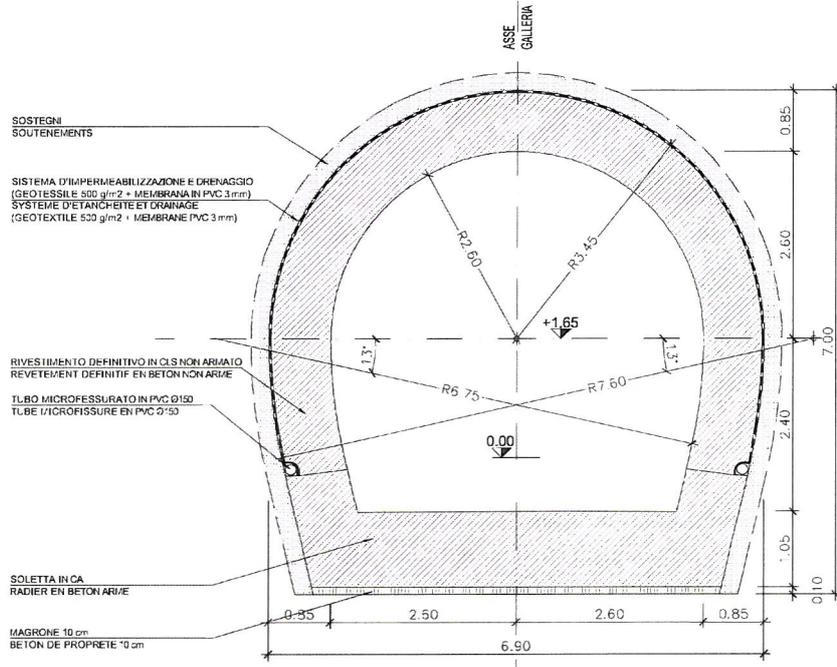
Carpenteria tratta scavata in tradizionale – Sezione cilindrica
